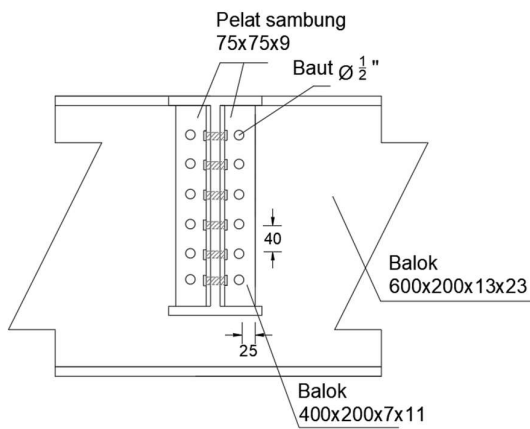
Denah Perletakkan Sambungan Balok – Balok
